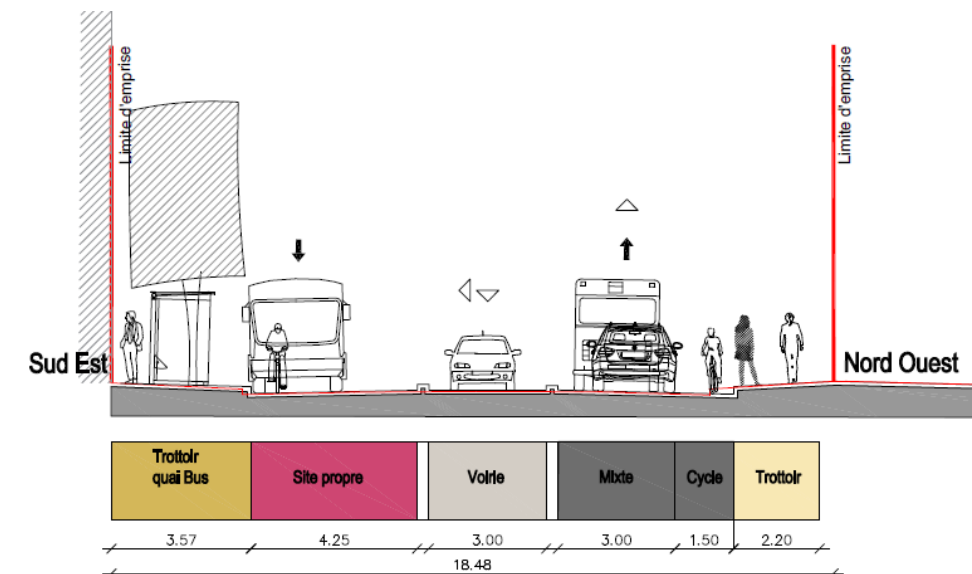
Coupe type en section courante sur le boulevard Léon Feix entre les rues Berteaux et Michelet
